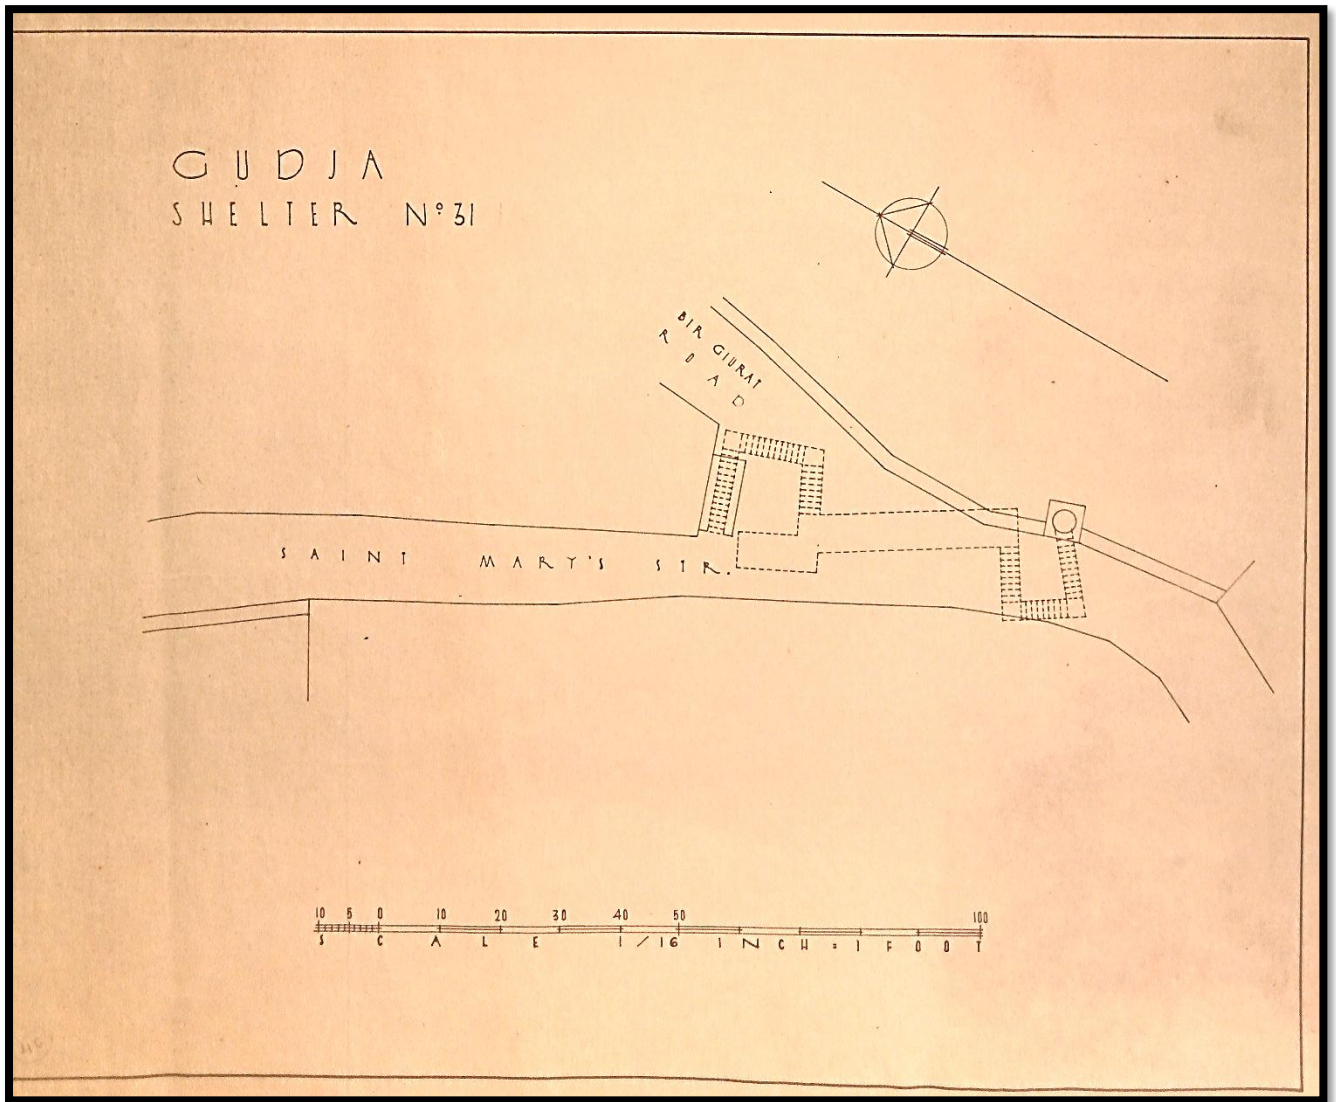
Planta do Abrigo nº31 "Saint Mary's Str."
